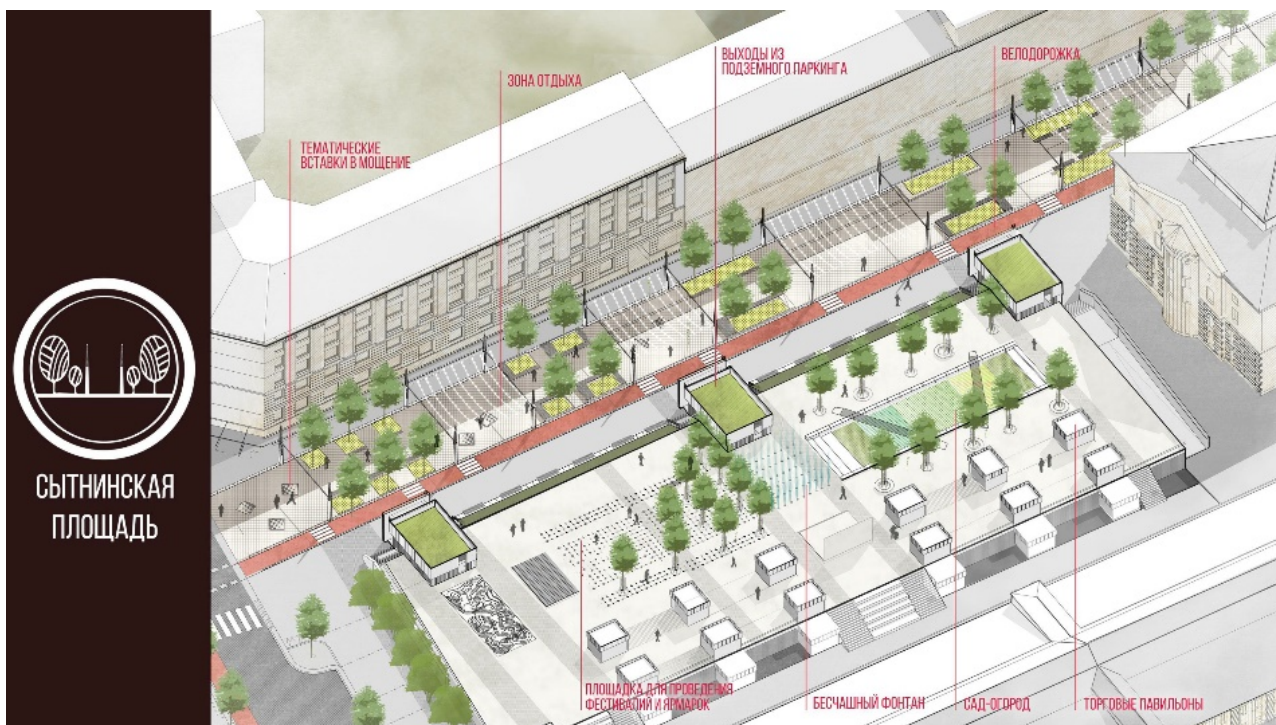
Новое многофункциональное открытое общественное пространство на эксплуатируемой кровле паркинга Сытного рынка и планируемая пешеходная зона Сытнинской улицы
